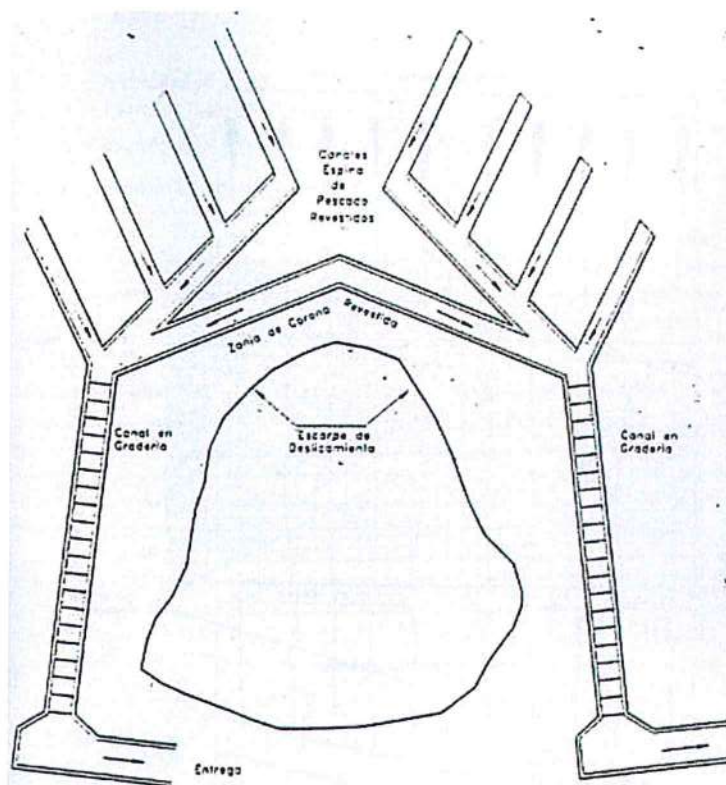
Esquema de planta de canales colectores espina de pescado con canales en gradería
